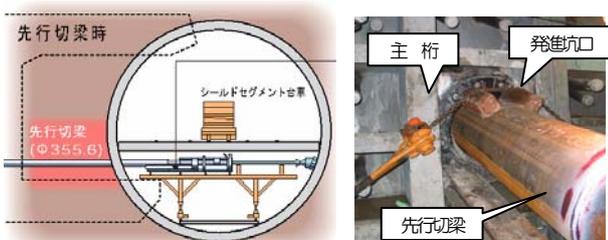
先行切梁の施工方法および施工状況<sup>5)</sup>
